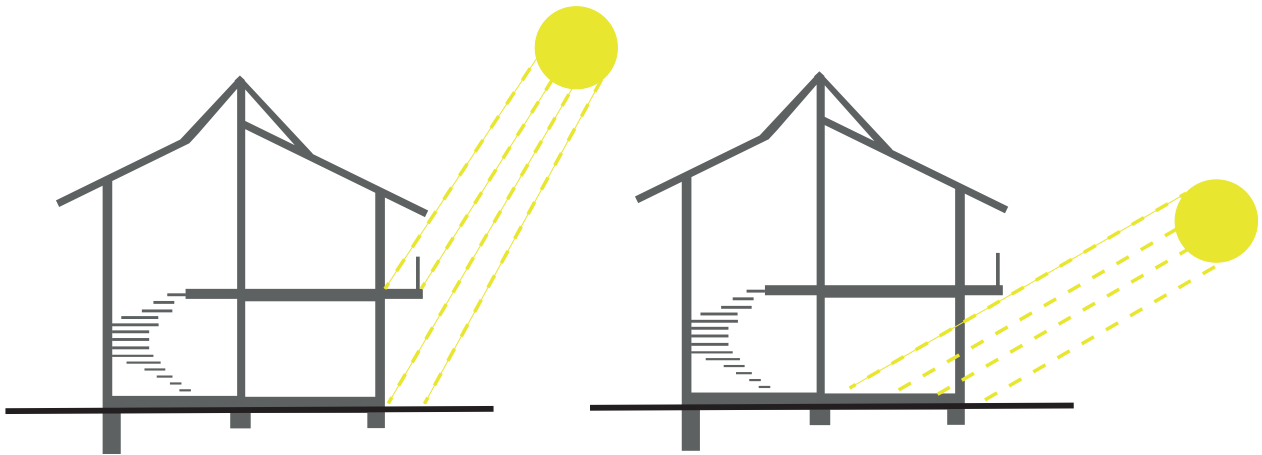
Verschattung der Fenster- und Fassadenflächen durch Dach- und Balkonüberstände
